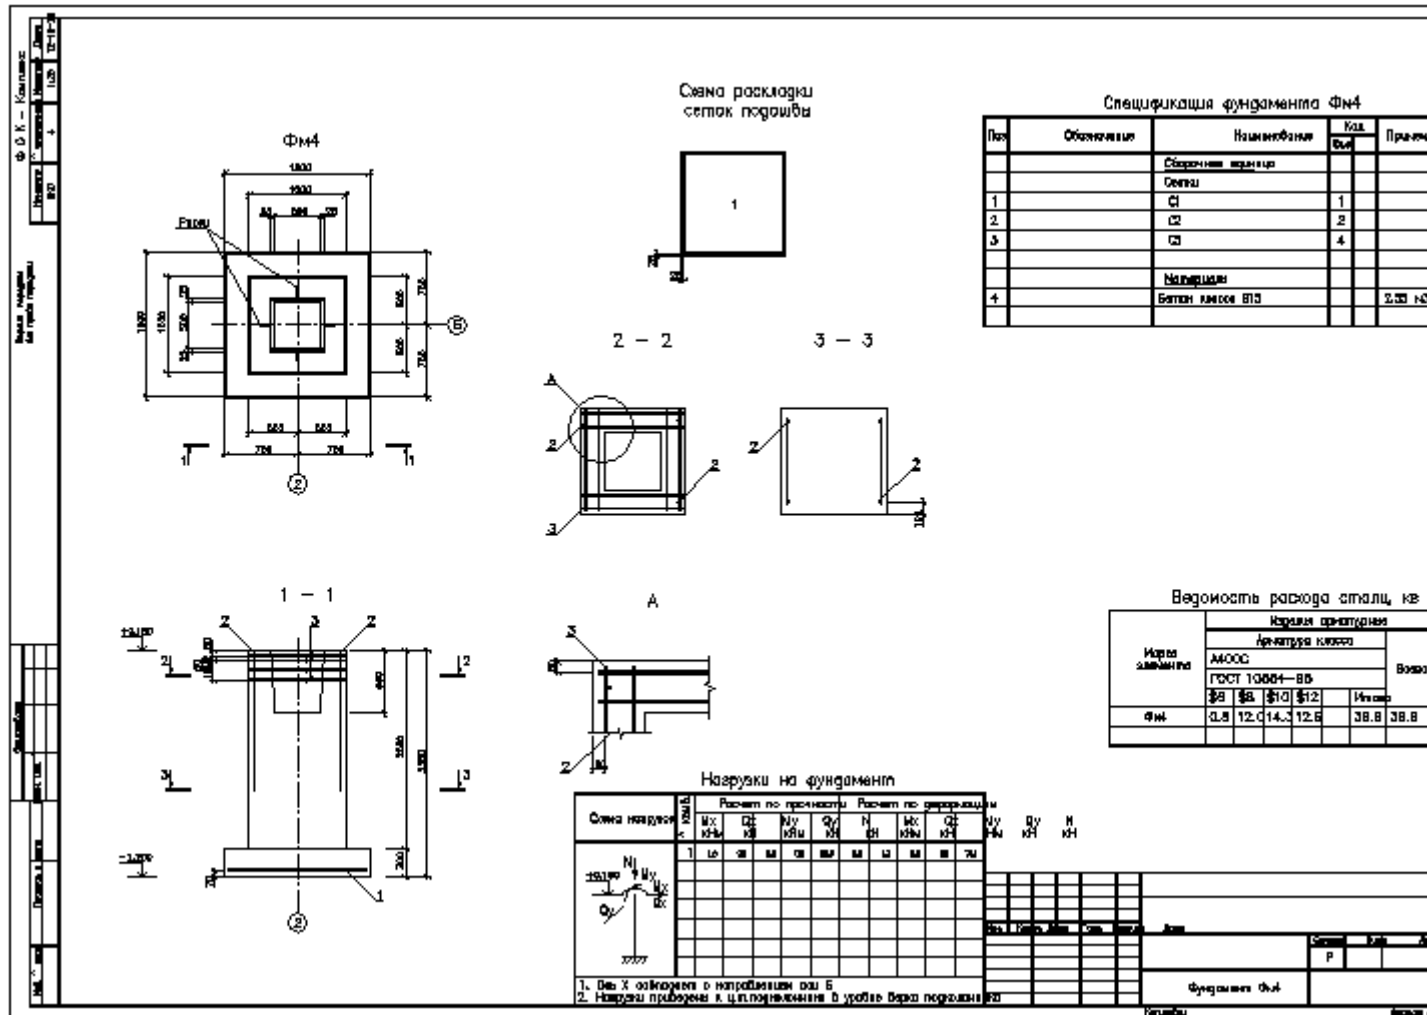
Фундамент ФМ4. Кресления рабочего проекта
